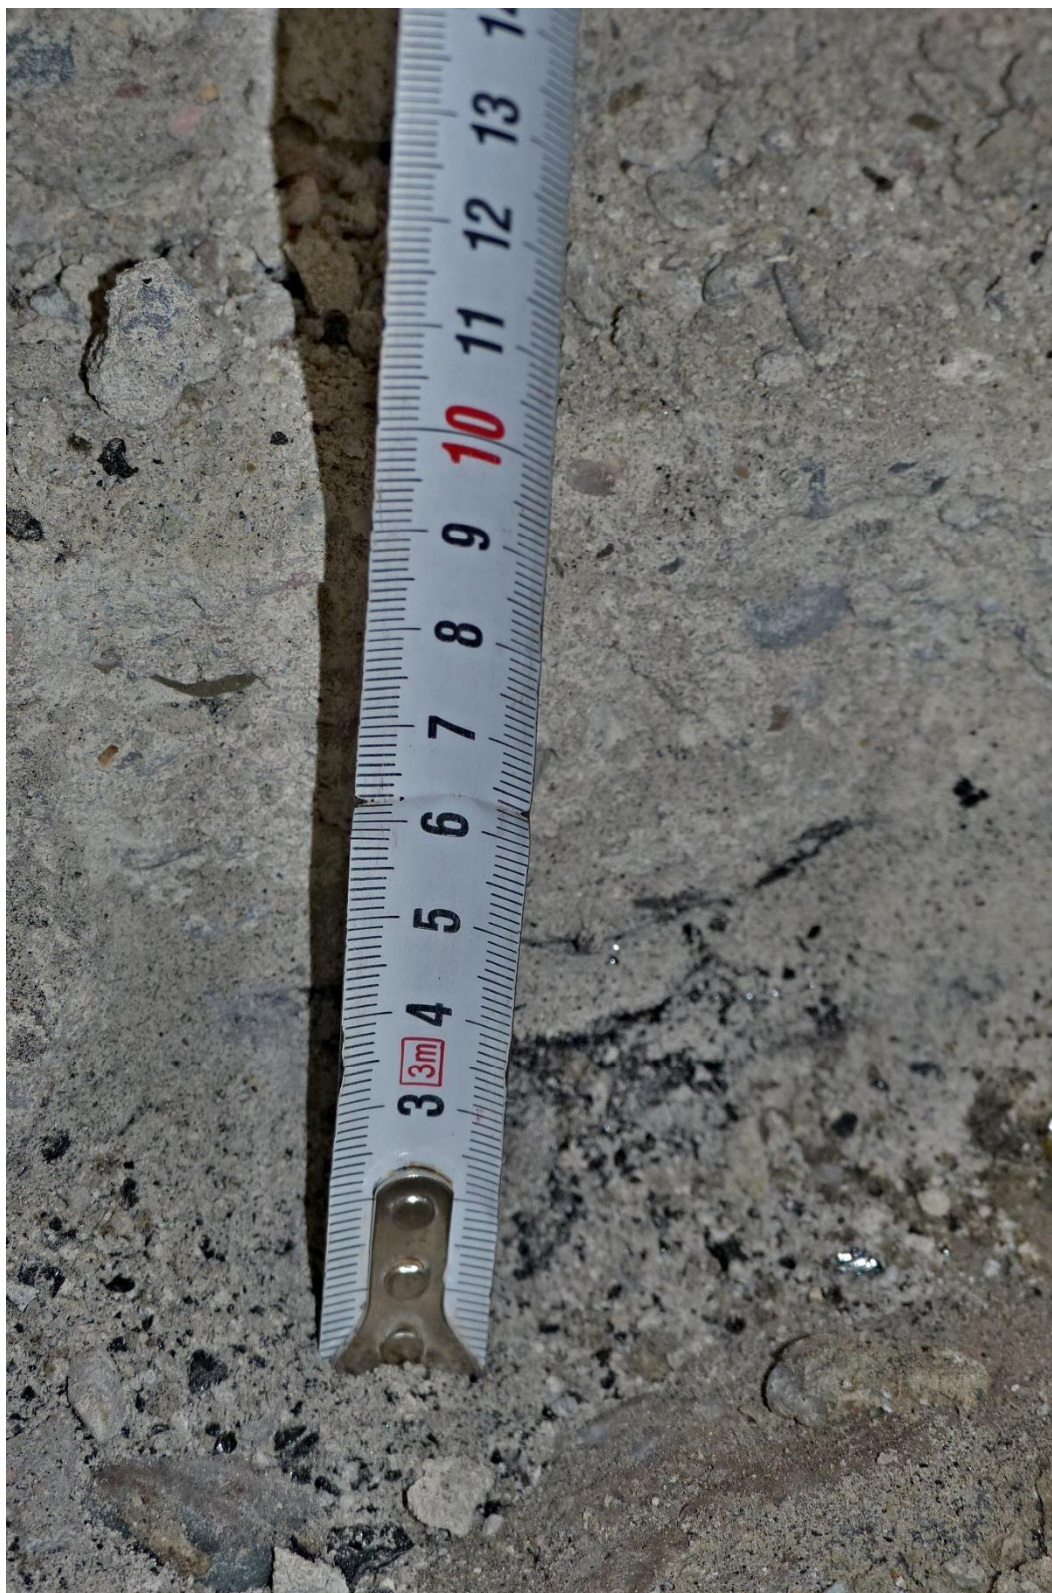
Detailní pohled na sondu P4 v místnosti OP41
